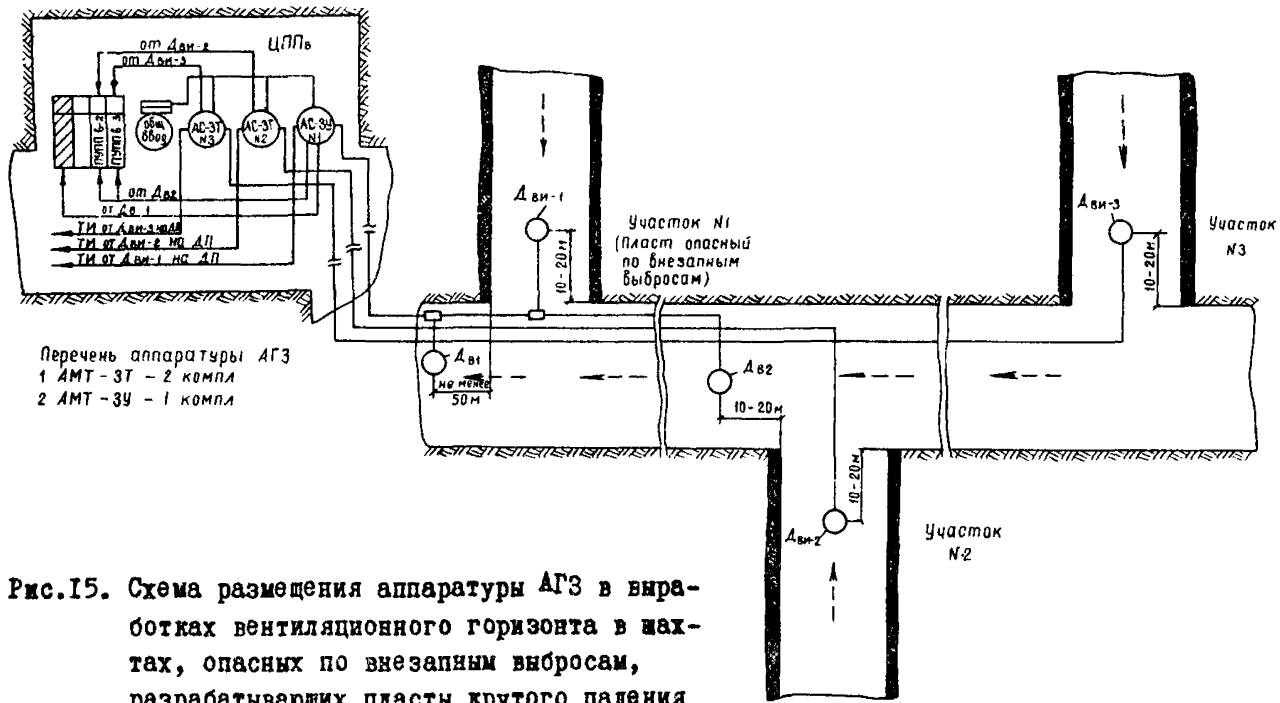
Схема размещения аппаратуры АГЗ в выработках вентиляционного горизонта в шахтах, опасных по внезапным выбросам, разрабатывающих пласты крутого падения
